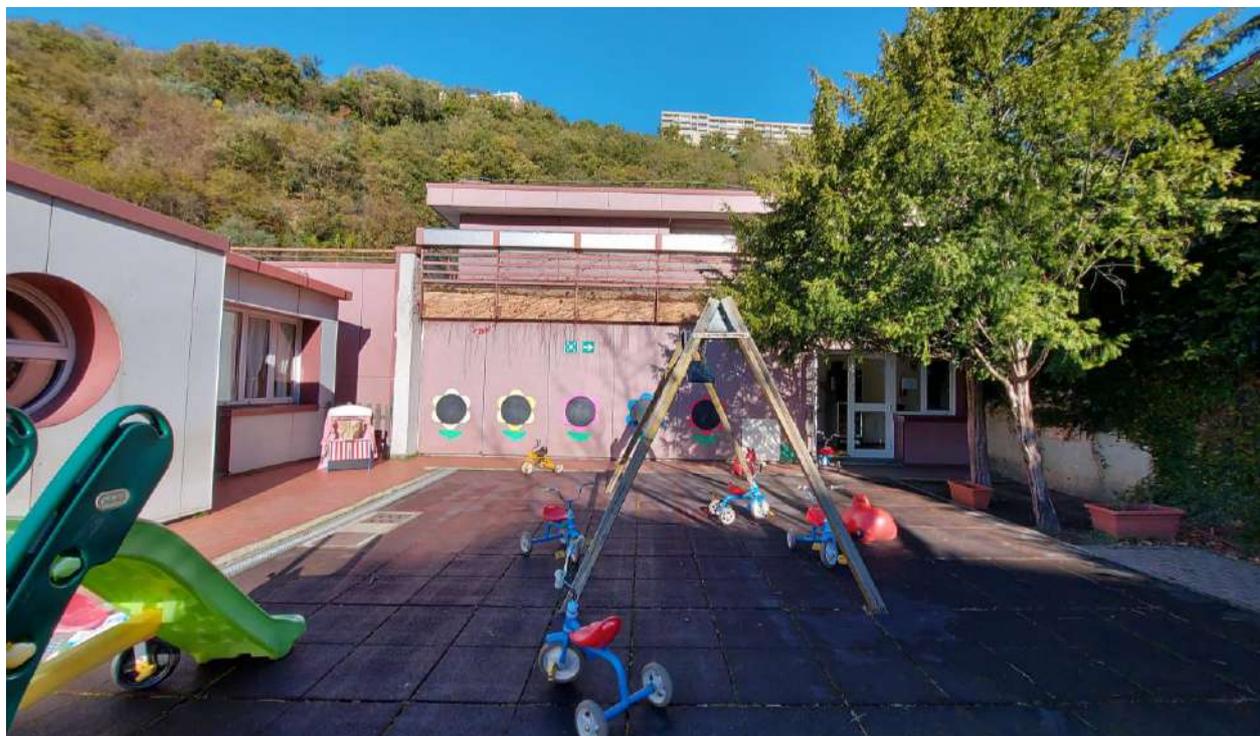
Piano Secondo, Scuola Materna Mimosa prospetto sud
